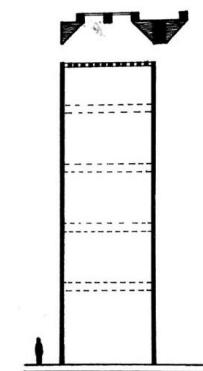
Corte Galería de Arte de la Universidad de Yale, New Haven, Connecticut, Estados Unidos
